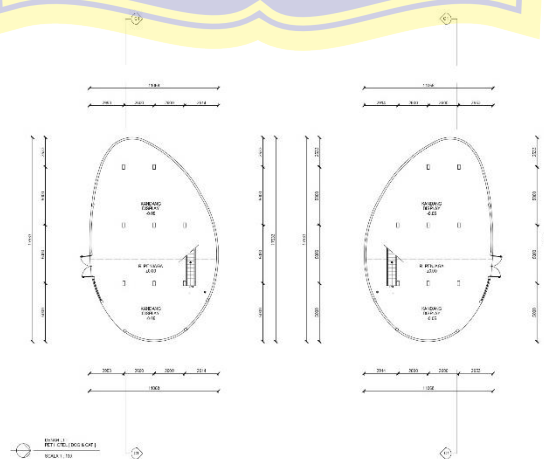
Lay Out Plan (Sumber : Penulis, 2025)
